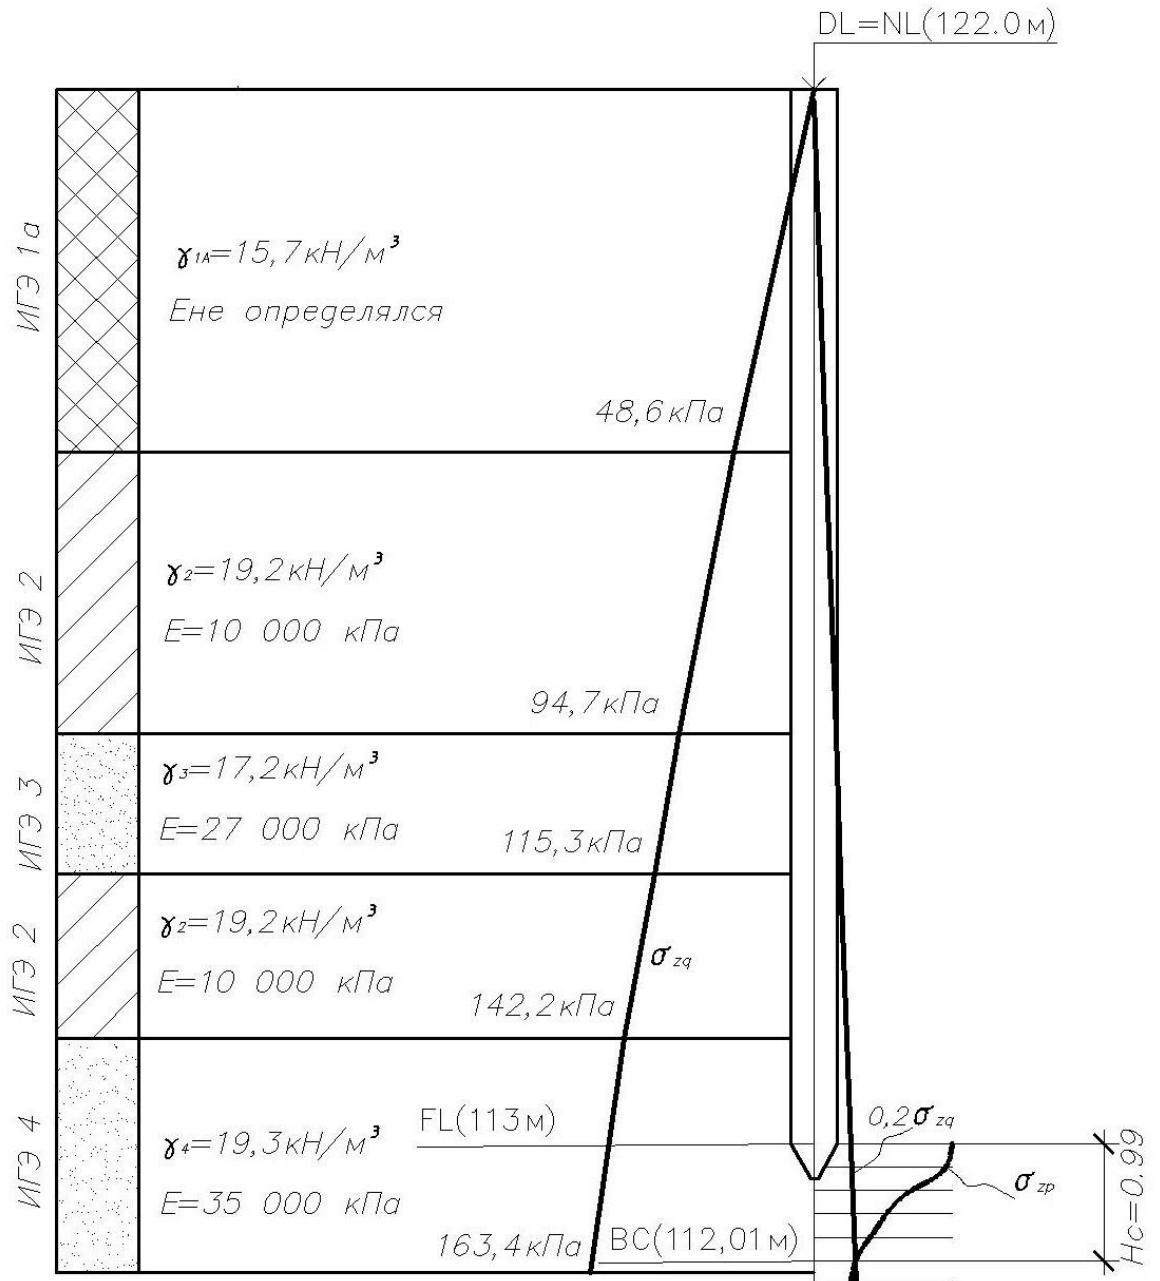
Схема для расчета осадки свайного фундамента
